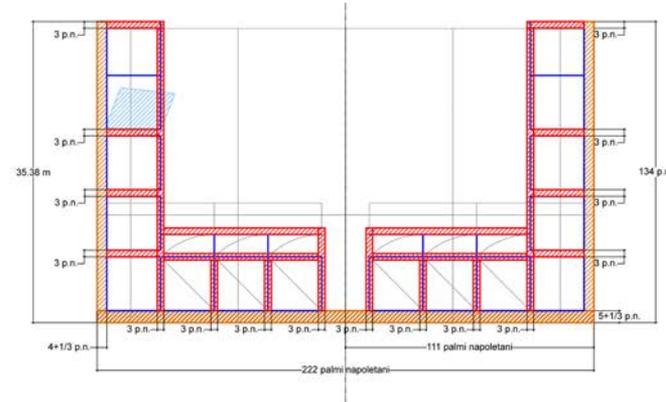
Nella pagina 12. Schemi geometrici della pianta del piano primo (Schema A, B)
